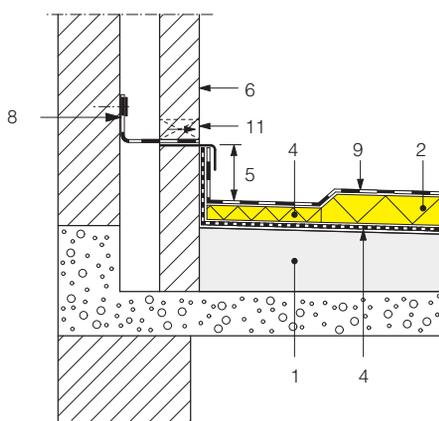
isolation d'une toiture existante dont la hauteur du relevé est limitée au droit du mur creux
